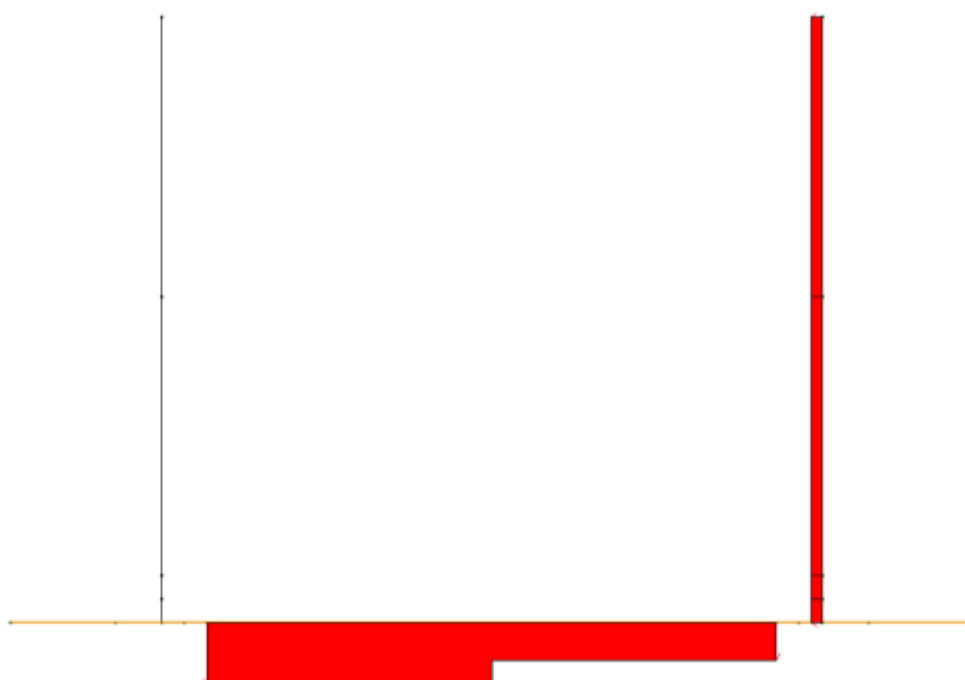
SPINTA DEL SOVRACCARICO 20 kN/M2 SUL PIEDRITTO DESTRO E SOVRACCARICO ACCIDENTALE SULLA SOLETTA DI FONDAZIONE (CDC 13)
